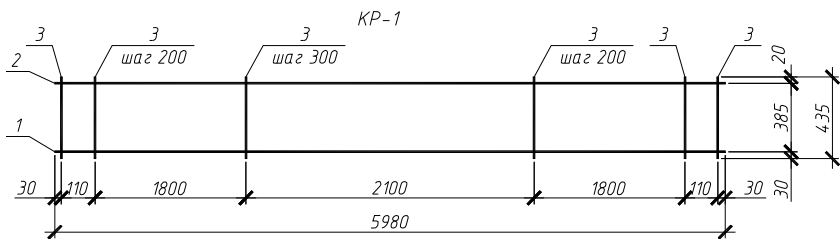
Плоский каркас КР-1 (к примеру расчета 4)
